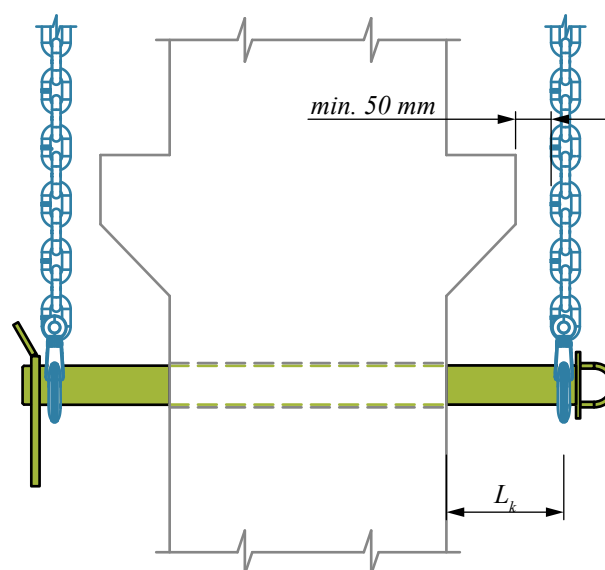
Distanza minima fra l'imbracatura e il pilastro con mensole.
